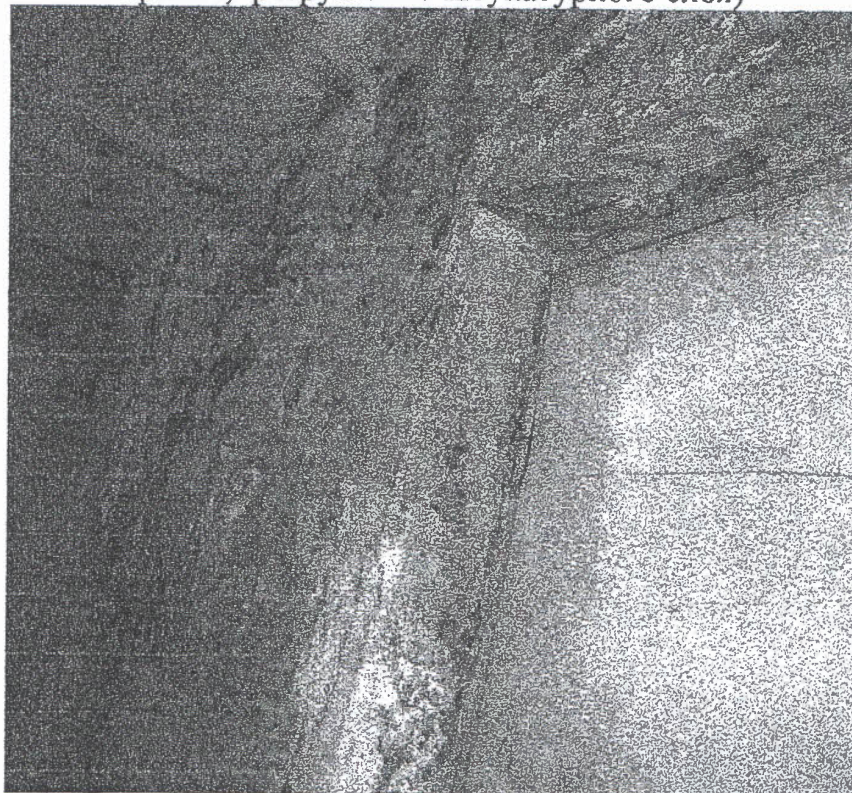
(4 этаж, перекрытие умывальной, разрушение бетона, коррозия арматуры в местах установки трапа)
